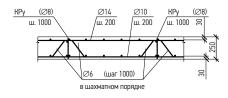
Принятая схема и поперечное сечение безбалочного железобетонного перекрытия, работающего в двух направлениях
